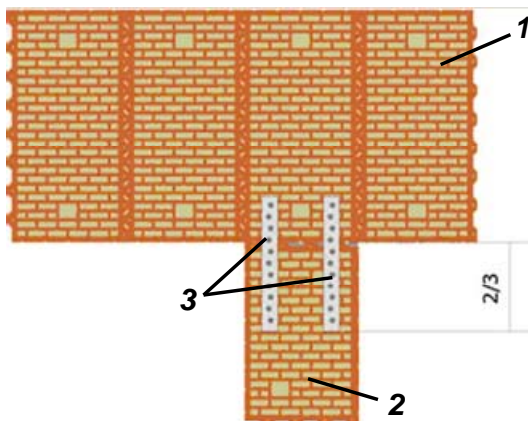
Узел перевязки внешней стены с внутренними стенами:
